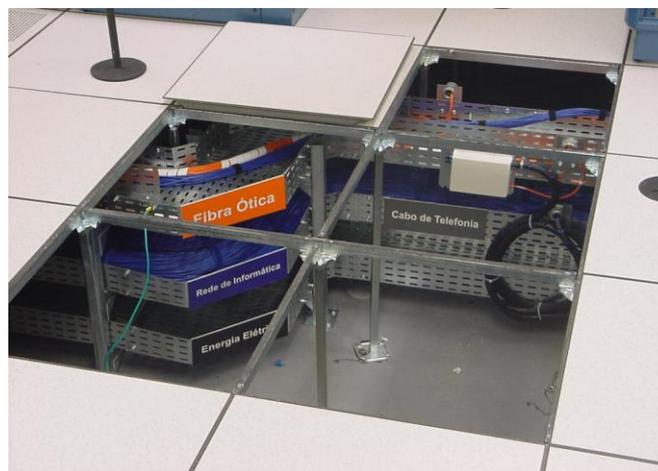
Ambiente com piso elevado e cabeamento estruturado sob o piso.
